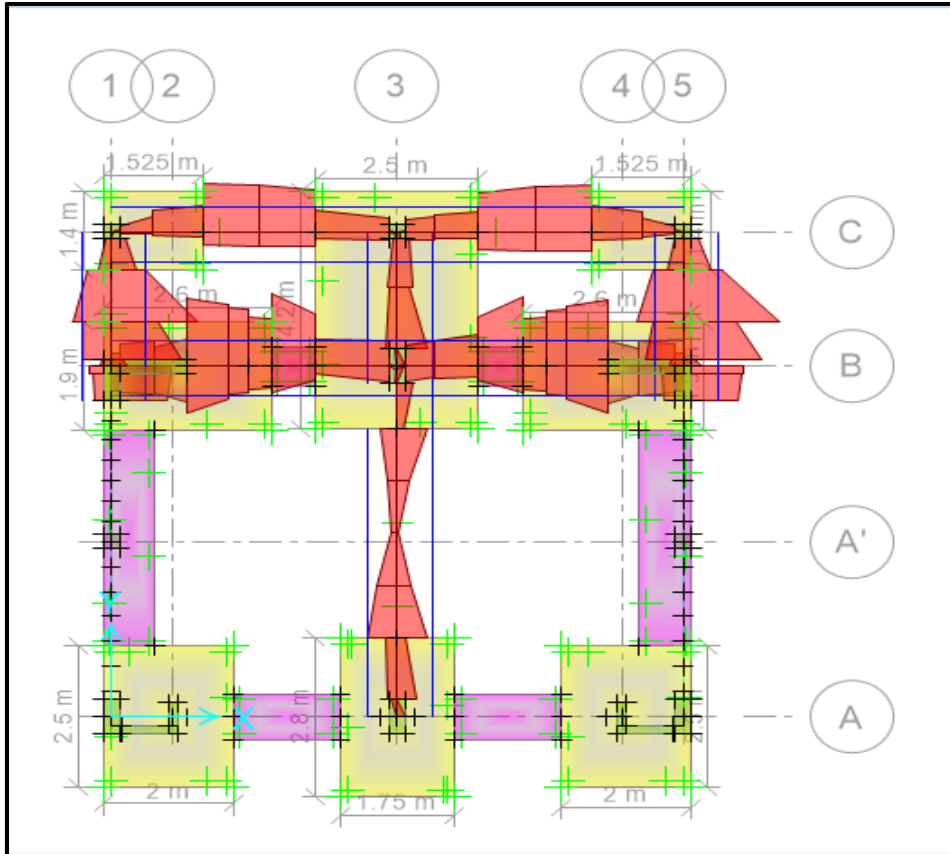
Detalle del acero longitudinal en las vigas de cimentación.
